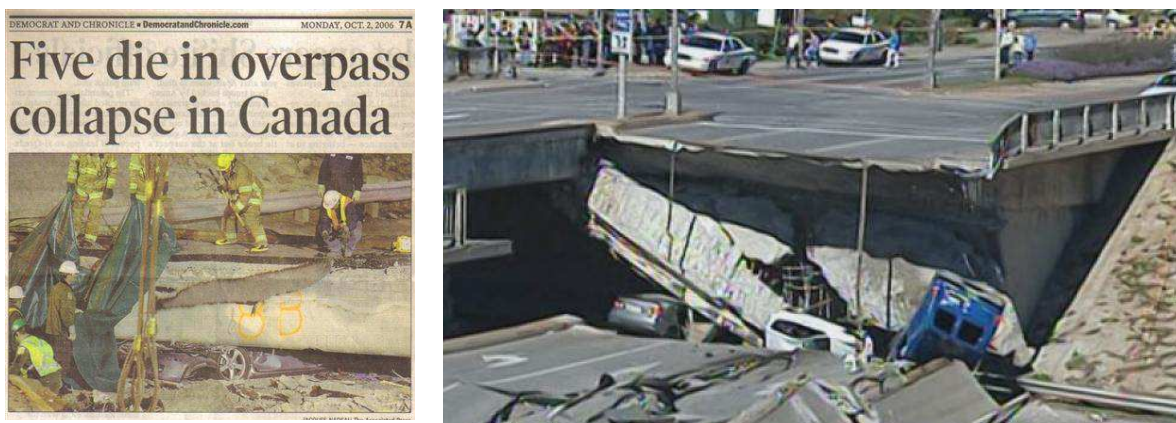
d. Colapso parcial en el puente de la autopista en Laval (Canadá 2006)
